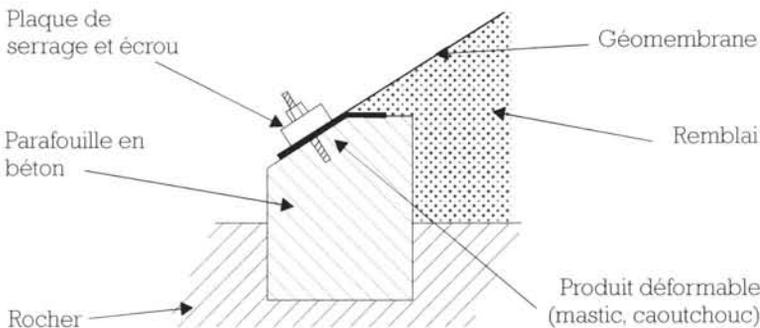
Raccordement à un parafouille en béton par serrage (d'après « Étanchéité des barrages par géomembranes : technique actuelle » - Bulletin n°78 de la C.I.G.B. - 140 pp -1991 - [56]) [56]).
